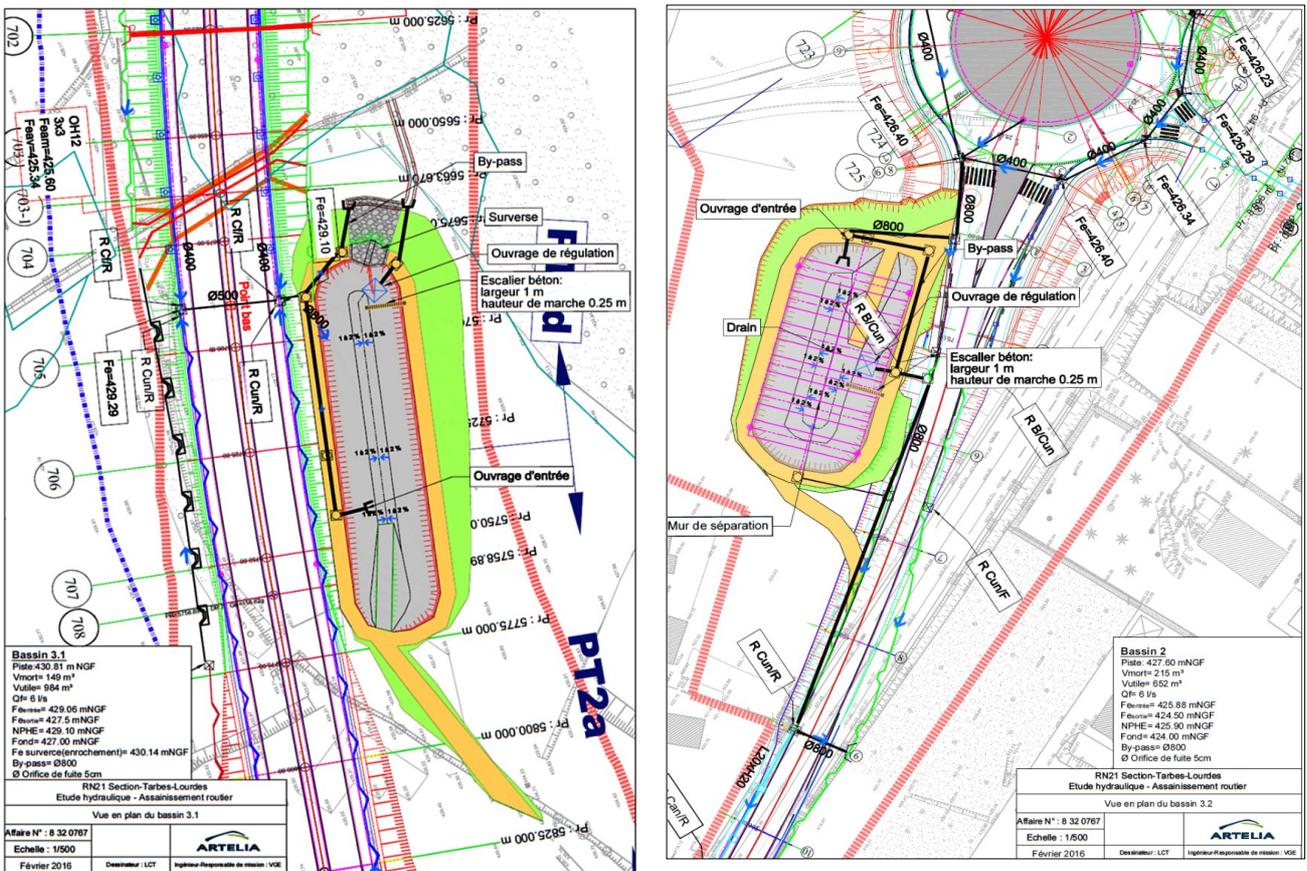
PLAN DES OUVRAGES 3-1 ET 3-2 (ARTELIA juin 2016)
